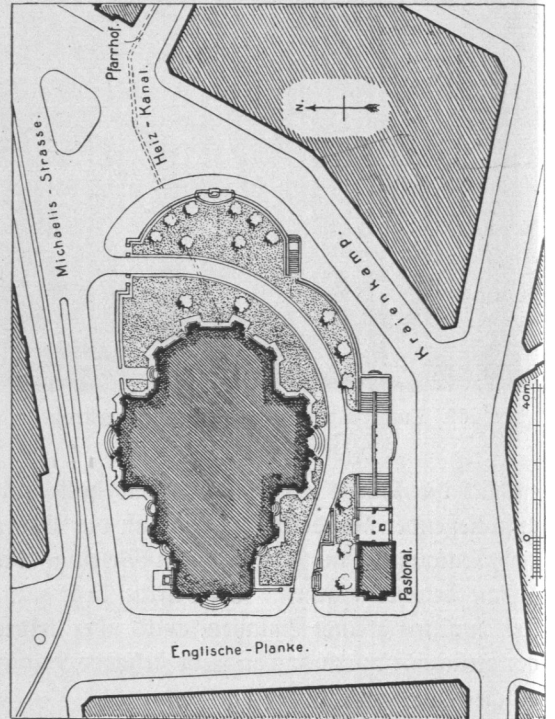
St.-Michaelis-Kirche, Lageplan.
